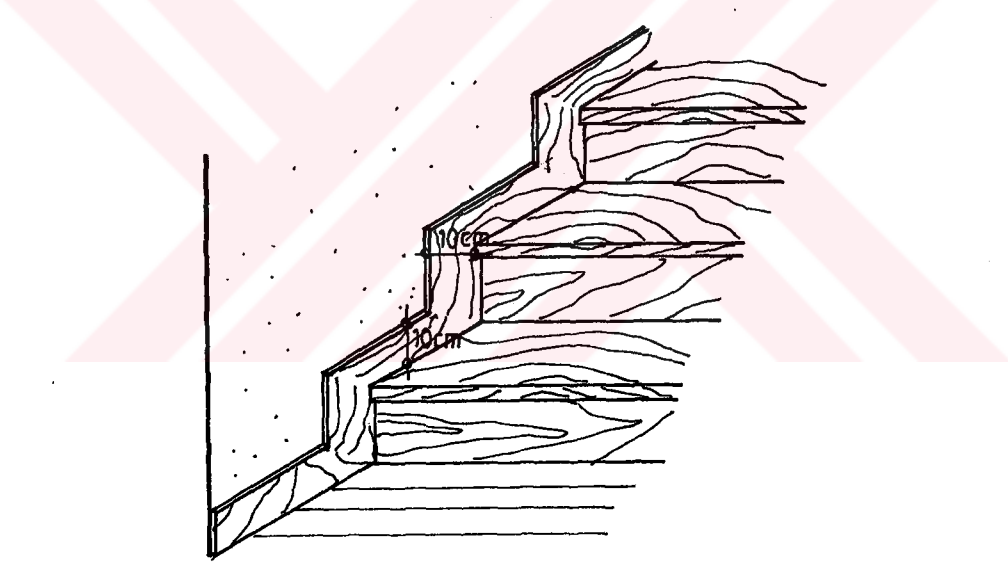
C tipi basamak profil detayı örneđi.
